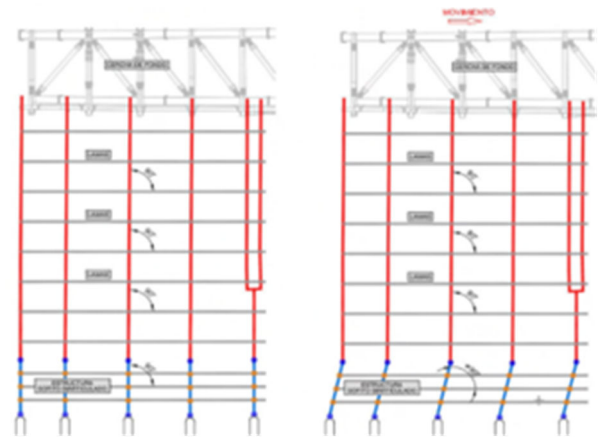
Fachada: Esquema de desplazamientos de fachadas N-S en dirección E-O
